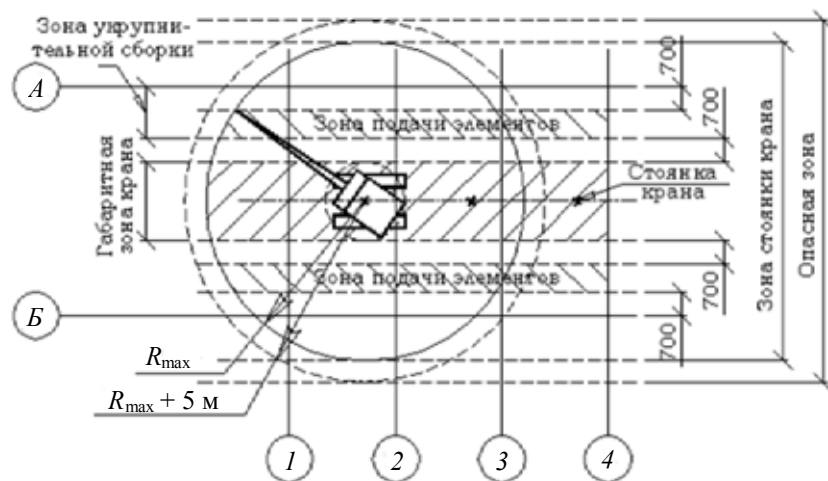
Схема организации монтажной зоны крана: А, В, 1–4 – оси здания
